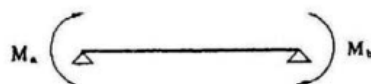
Trave soggetta a momenti d'estremità
